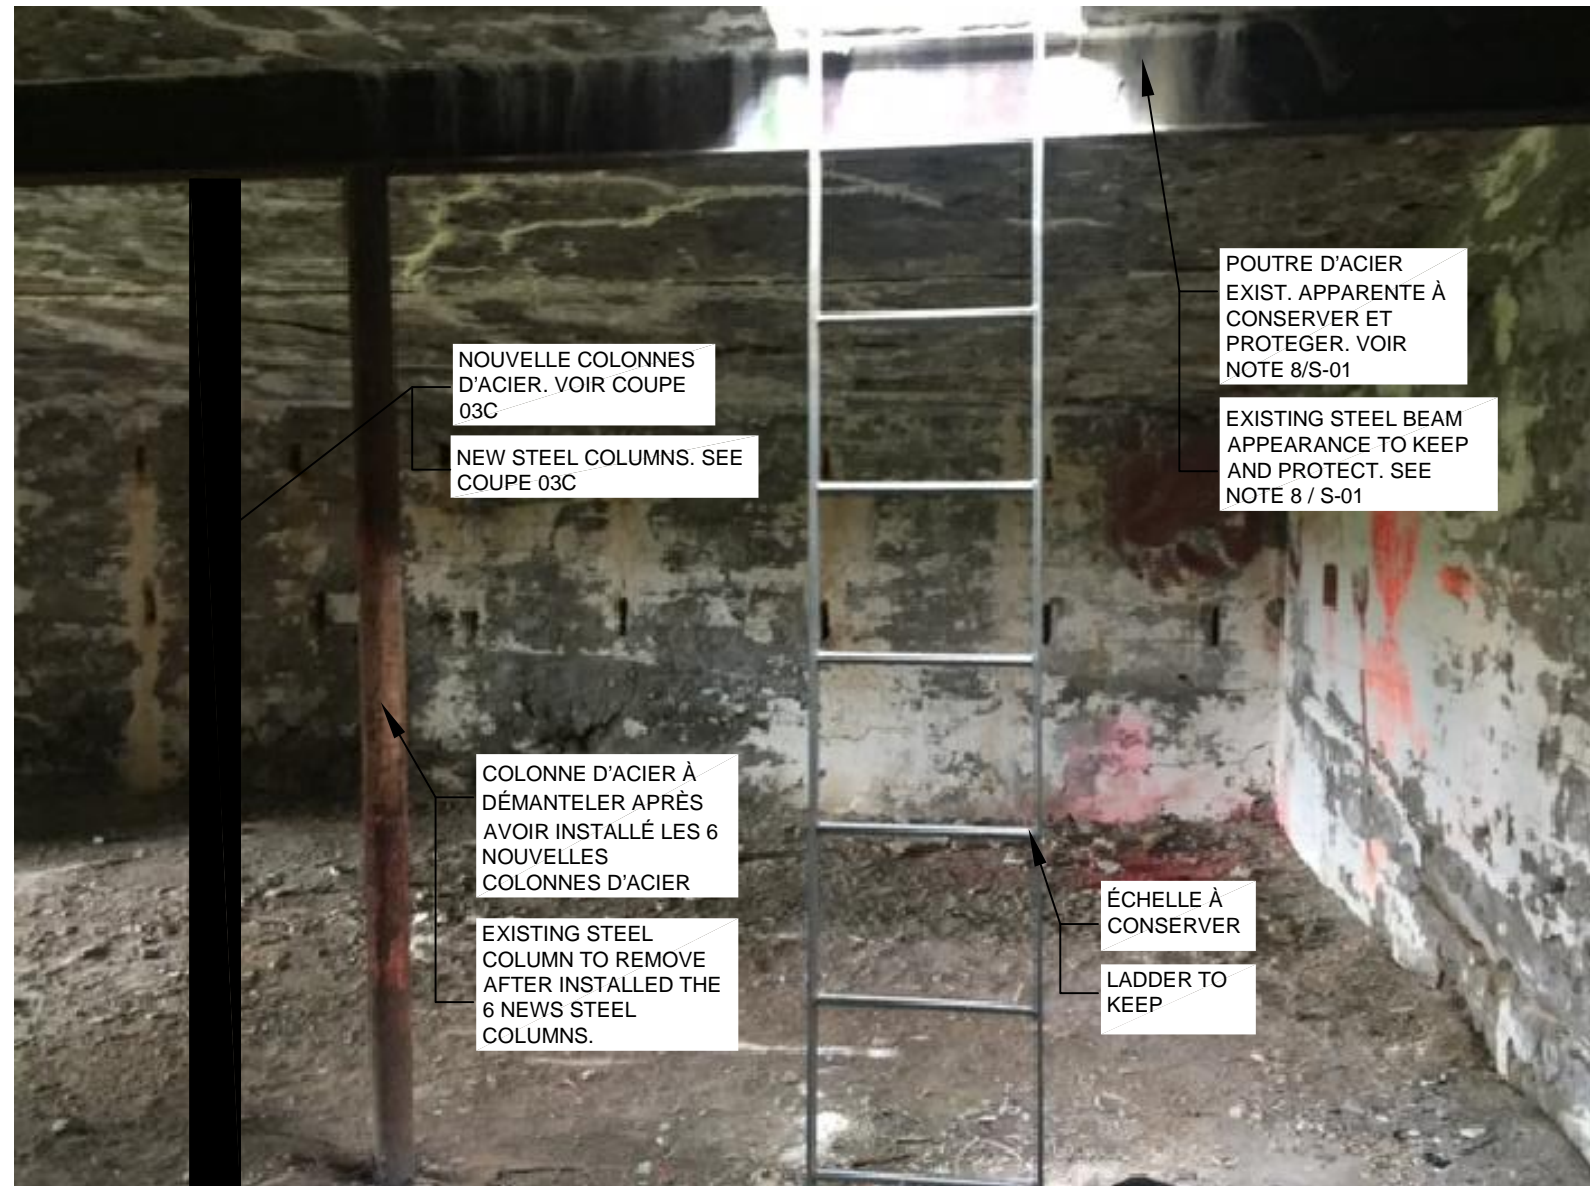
VUE INTÉRIEURE DU PILIER / INTERIOR PILLAR VIEW
